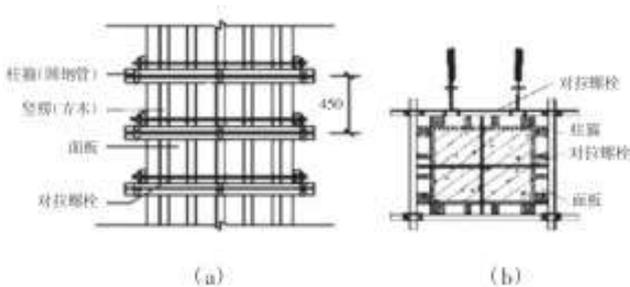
模板支撑的柱立面、柱剖面示意图 (mm)
